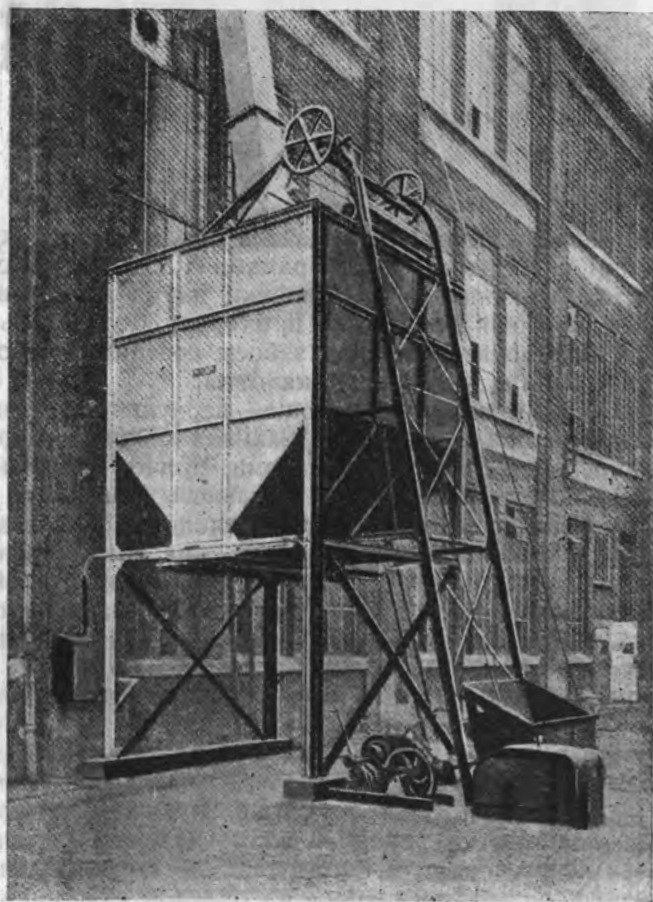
Шахтный ствол, оборудованный металлическим бункером с элеватором (скиповой подъем).
